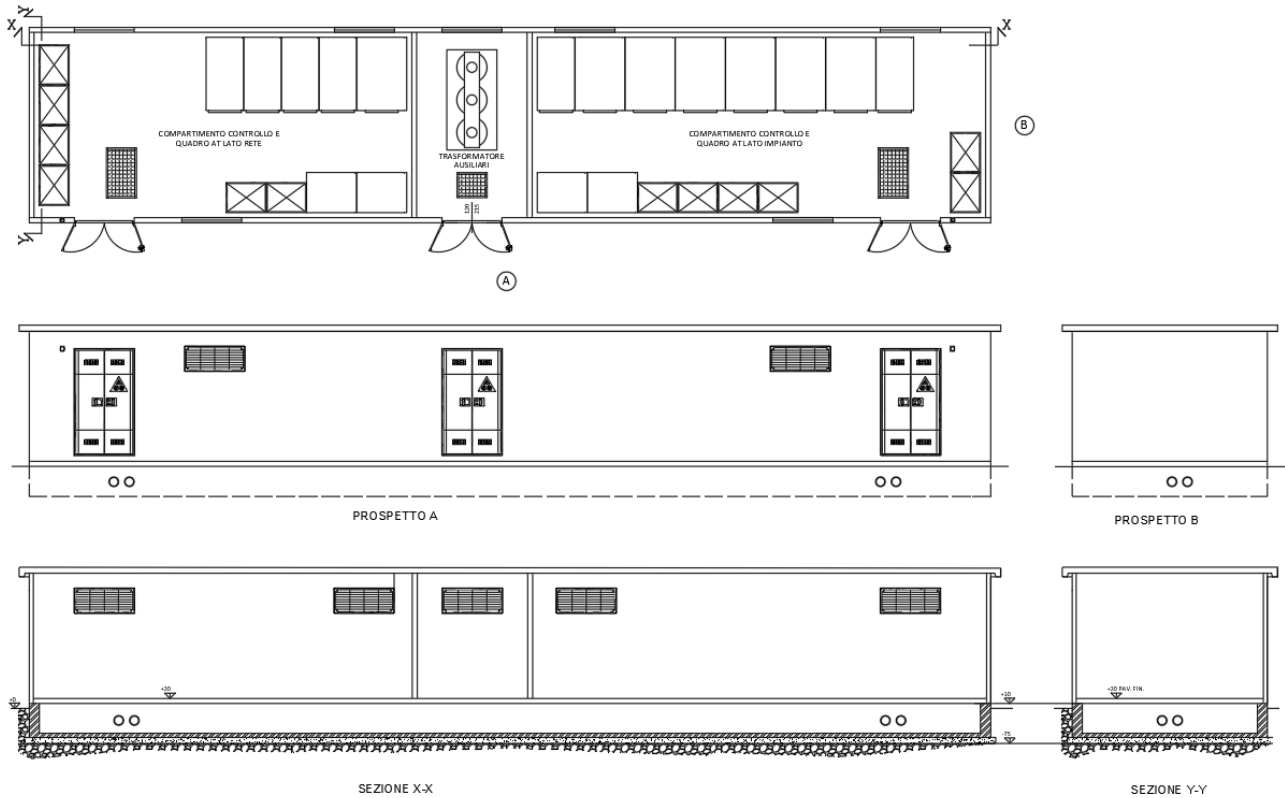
Pianta, Prospetti e Sezioni Cabina di Raccolta
